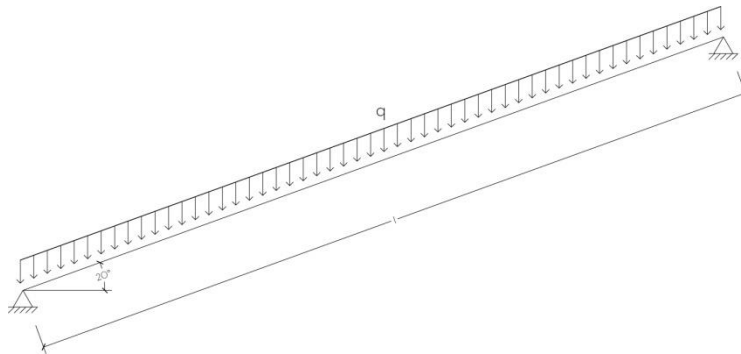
, Schema statico travetto di copertura. Fonte autore tesi
